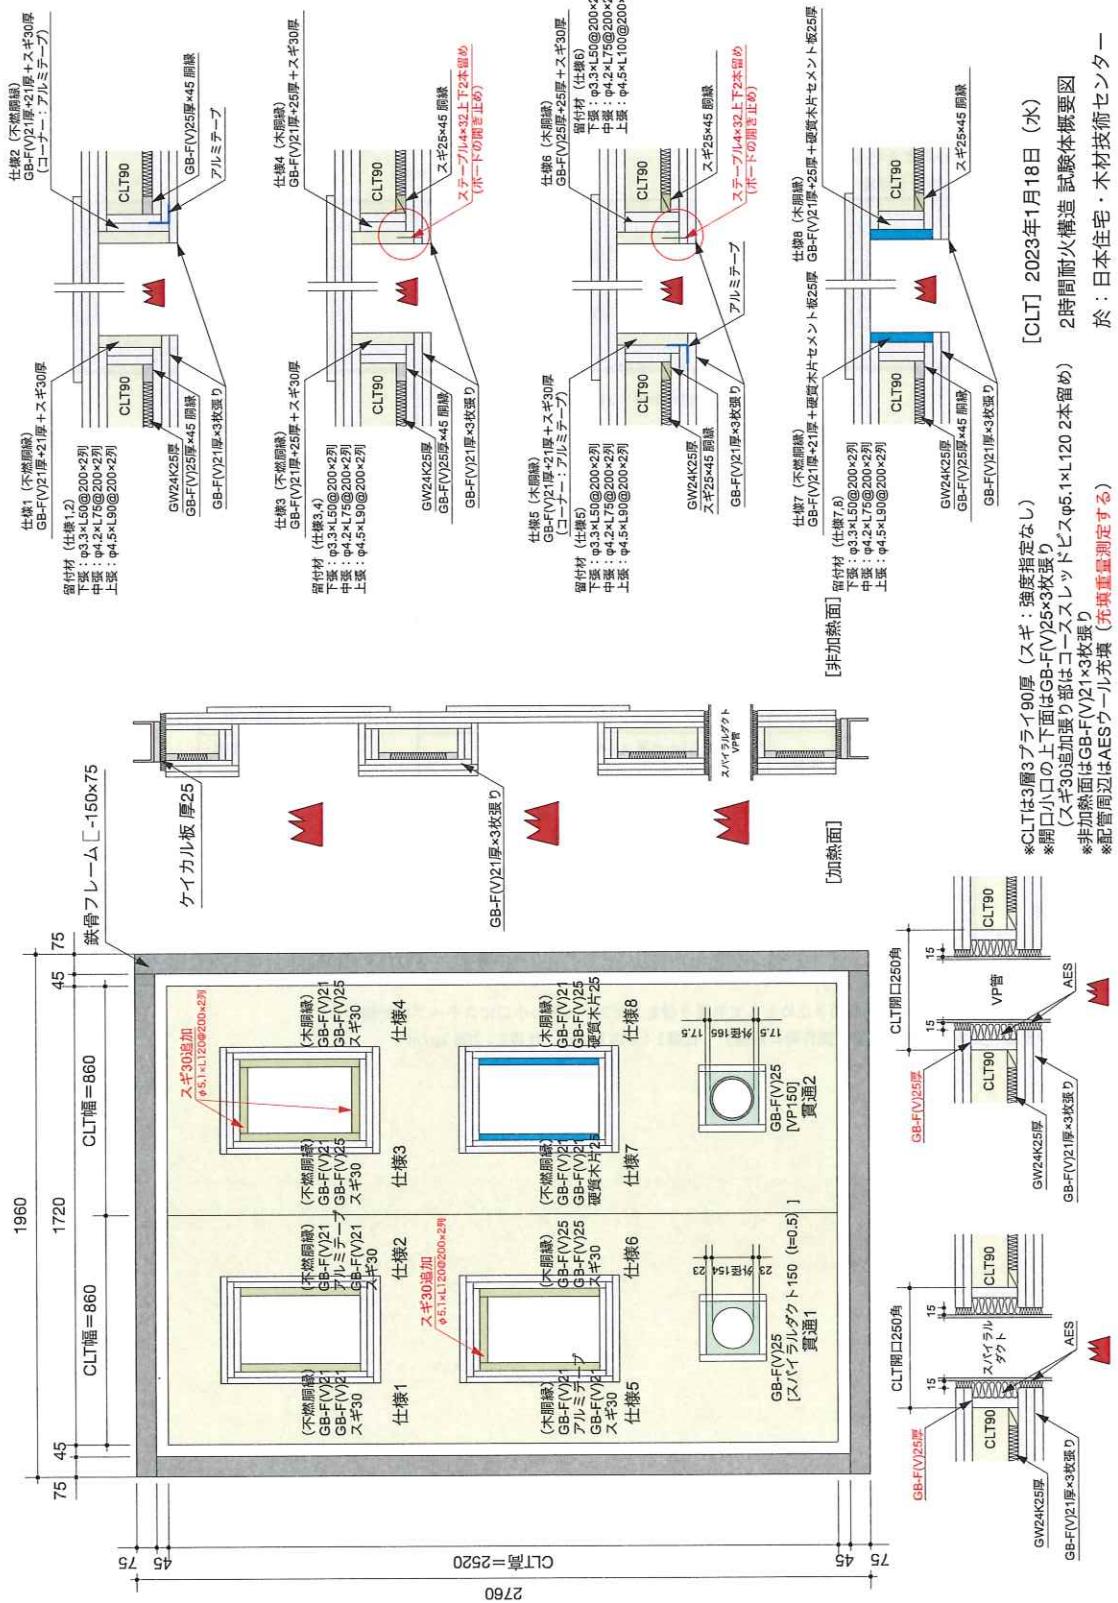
試験体 2 の構造・寸法 (単位: mm)
